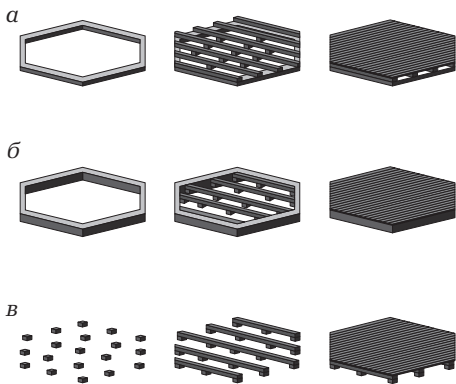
Устройство полов с установкой балок: а — на многоугольный фундамент; б — на уровне фундамента; в — на столбчатый фундамент
